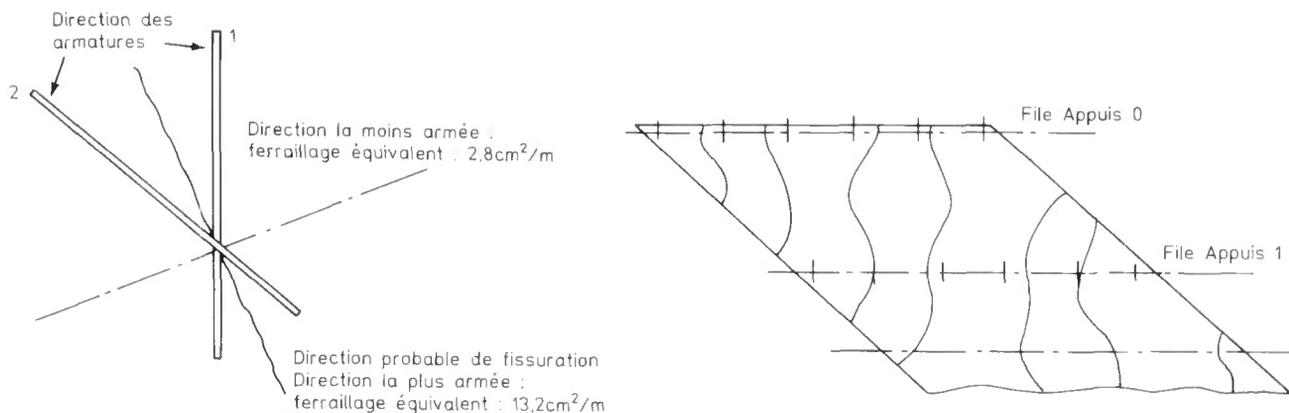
Fissuration d'une dalle biaise.
